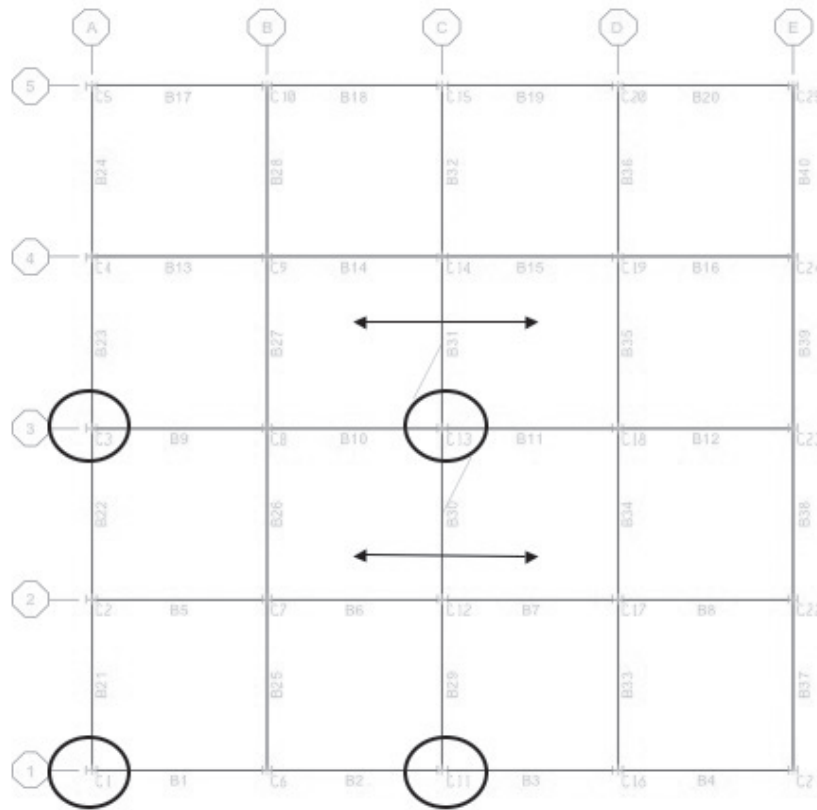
Identificación en planta de las columnas a estudiar. Dirección de las correas Este-Oeste (ver flecha “↔”).
